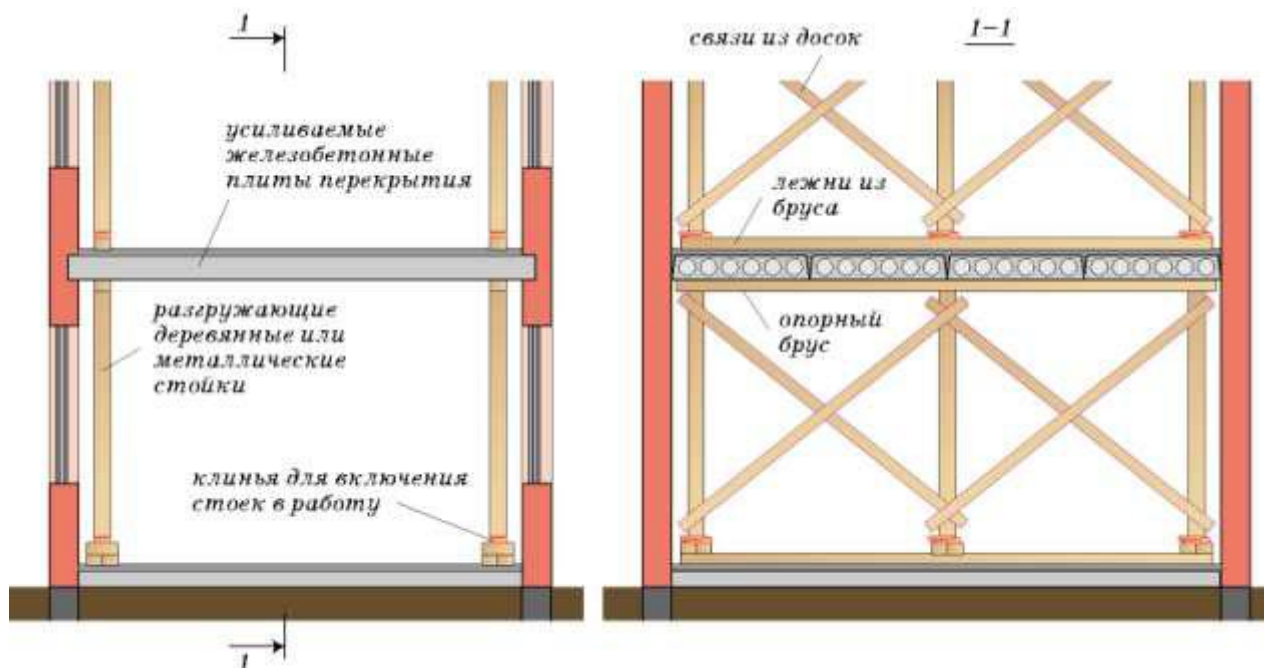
Подведение стоек вблизи опор для временного усиления плит перекрытия
